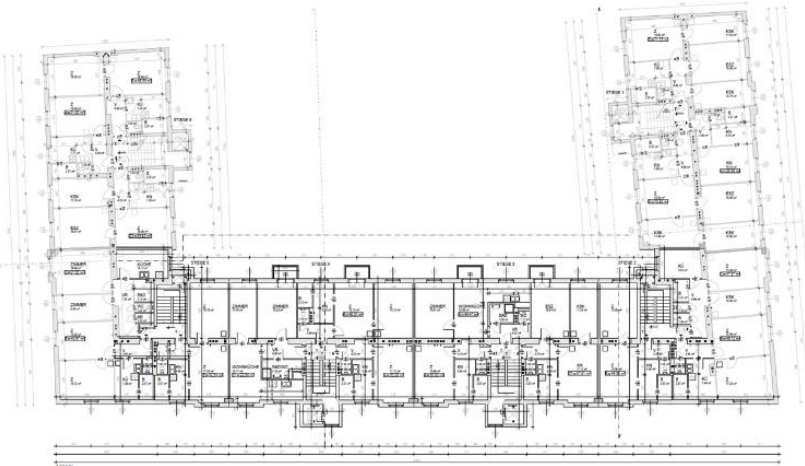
Verwendeter Grundrissplan des 3. Stockwerks für den Modellaufbau in IDA ICE in der Gerlgasse (eigene Darstellung).
